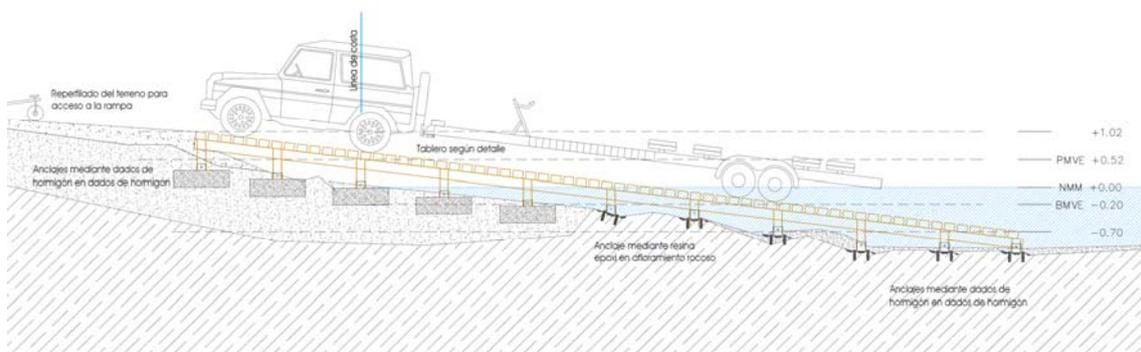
Planta propuesta para la instalación de la rampa de varada
